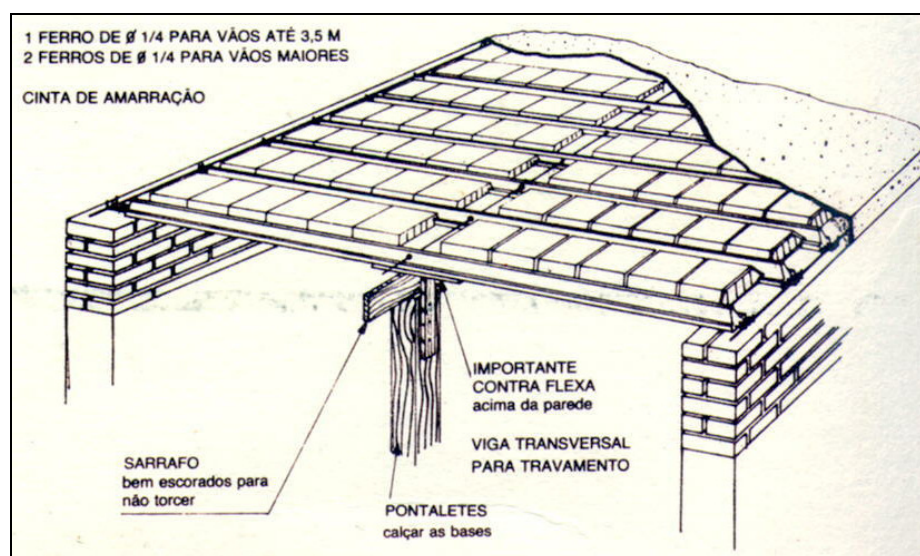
Nervura de travamento (LAJES ALMEIDA).
